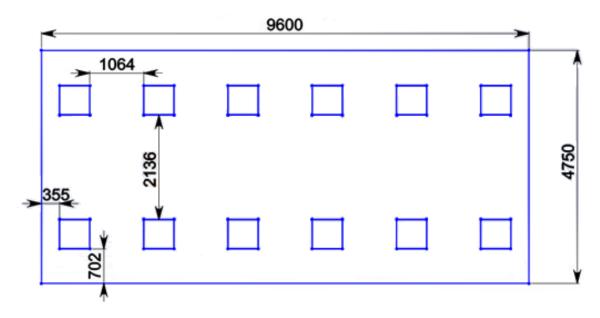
План помещения и размещения светильников со светодиодными лентами
